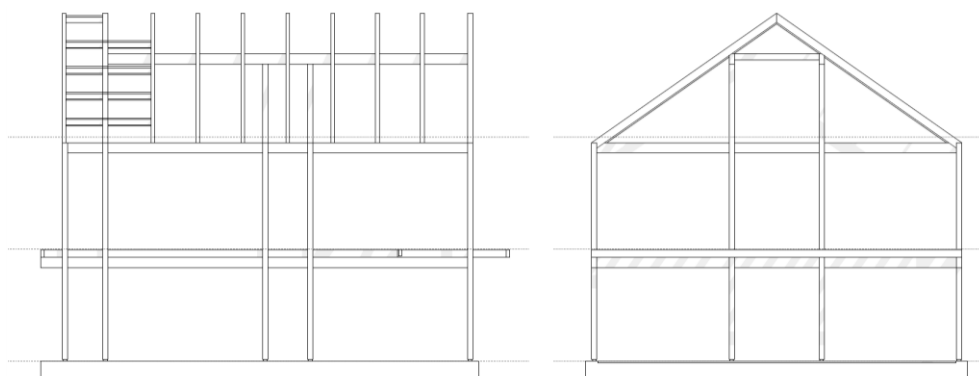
Alçados Oeste e Sul com a estrutura de pilares e vigas.
